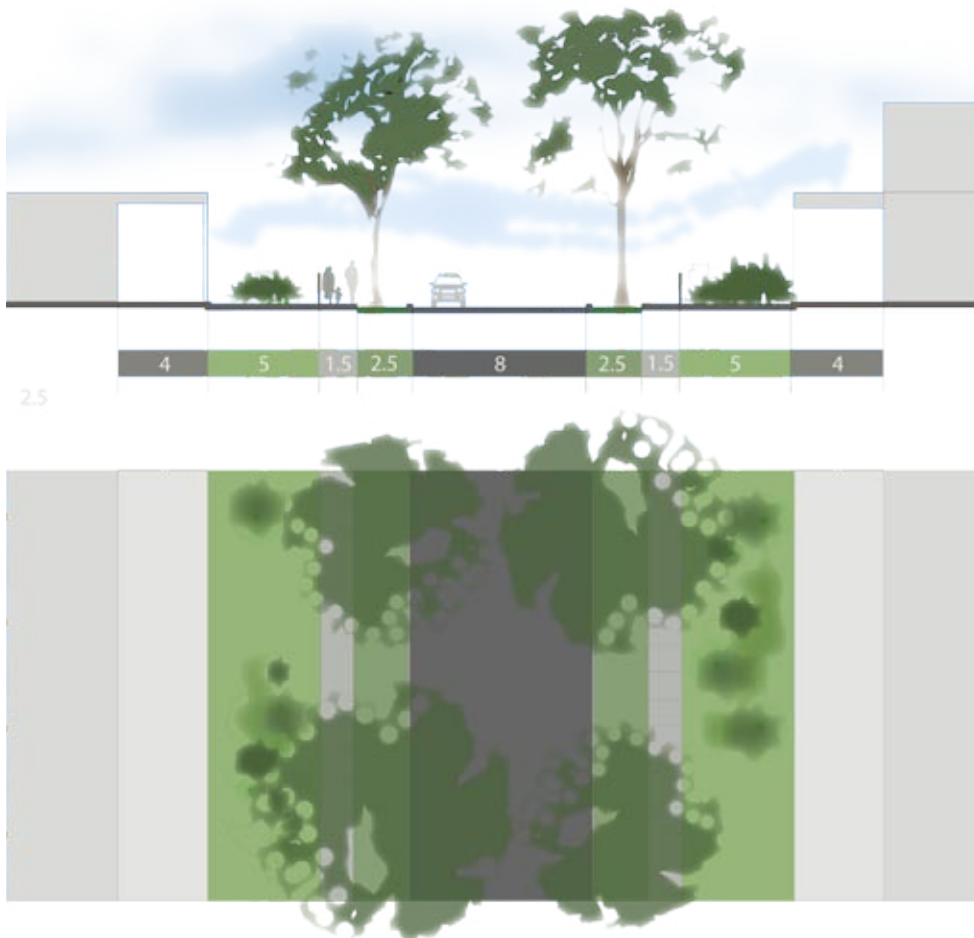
Esquema en sección y vista superior de una calle de El Vedado. Fuente: elaborado por los autores.
